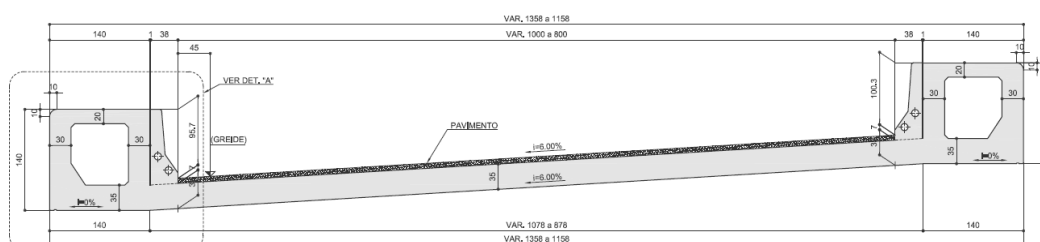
Seção transversal típica dos tabuleiros estaiados.
